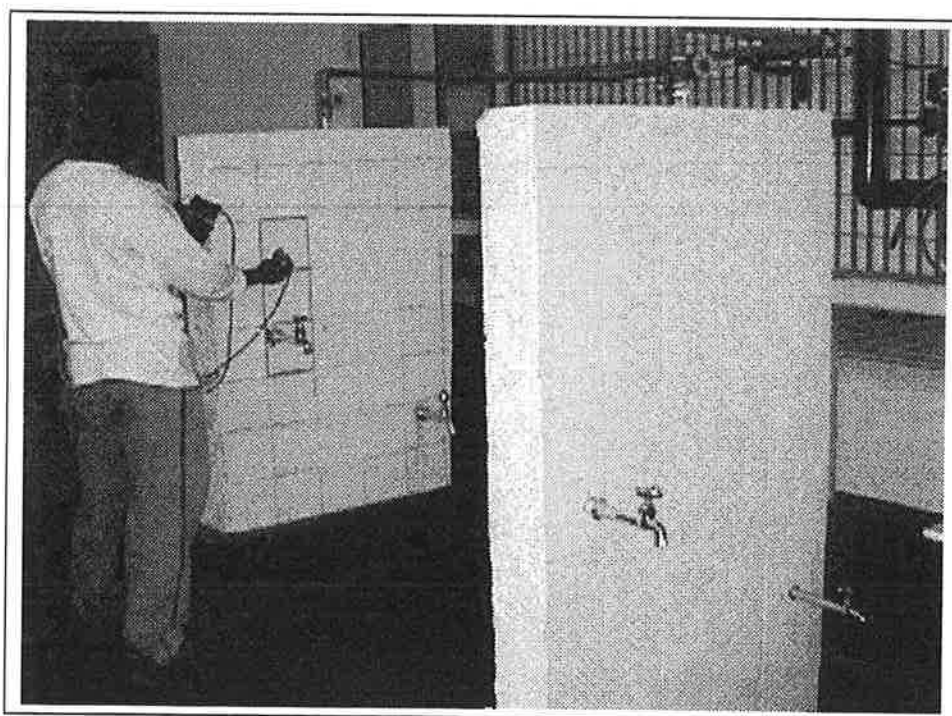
Realização do ensaio de vazamento no painel de bloco cerâmico, com a utilização de geofone eletrônico.
